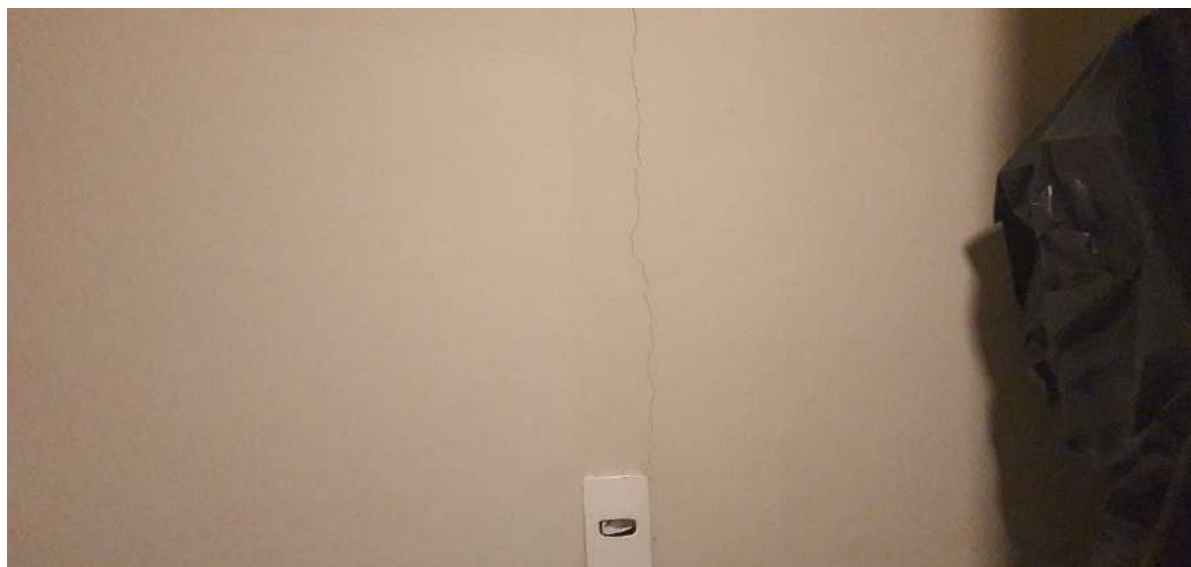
GUARITA, FISSURA NA ALVENARIA E TOMADA AFUNDADA.
